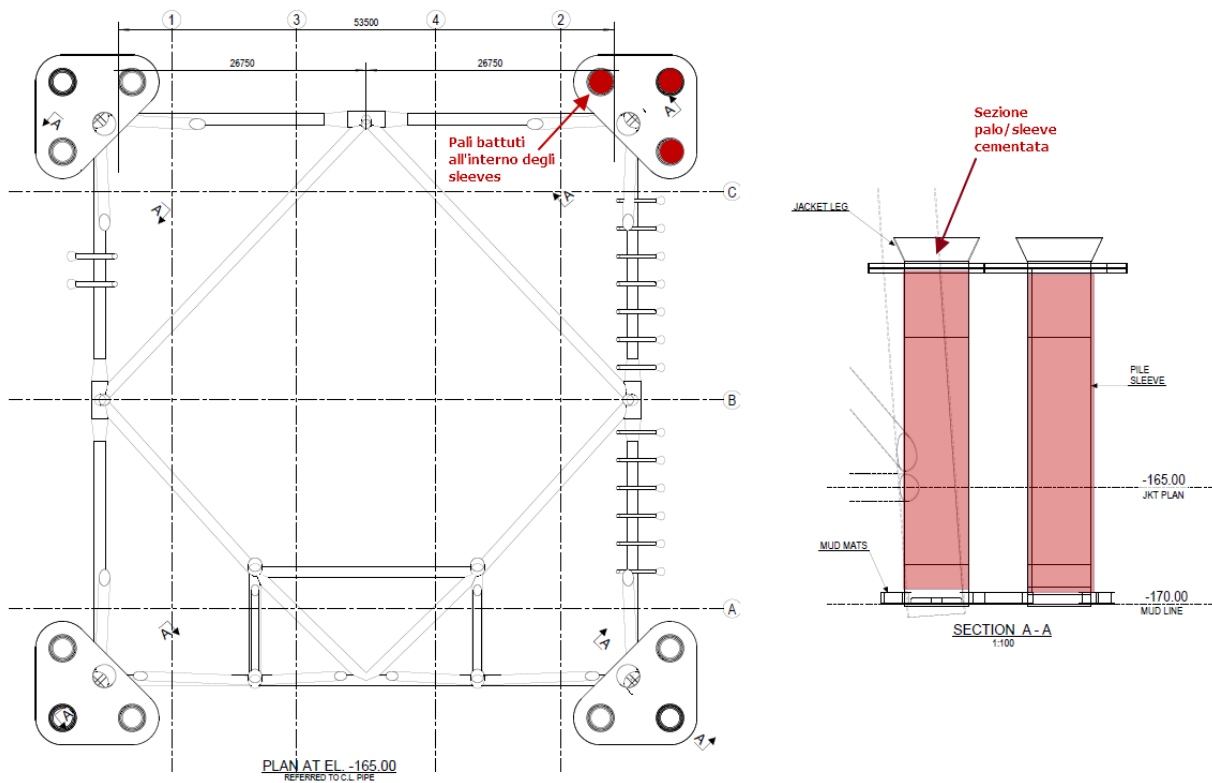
Jacket - sezione orizzontale in prossimità del fondale e sezione verticale connessione al palo
